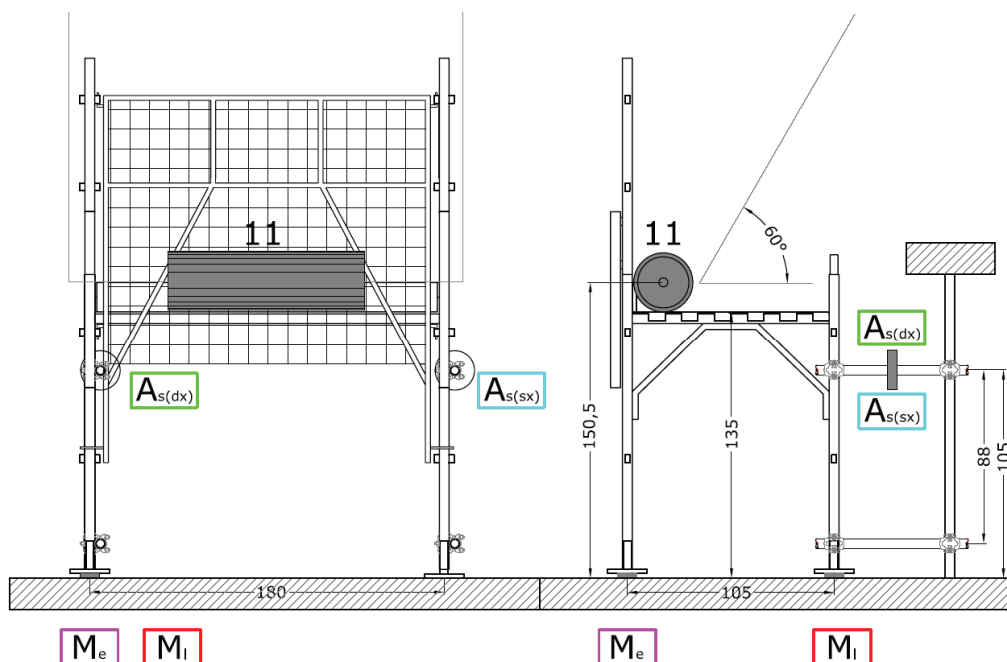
10 Prove d'impatto con rullo cilindrico su protezione continua – Schema CSR – Posizione degli strumenti di misura
